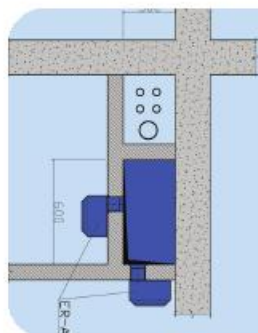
Установка 2 вентиляторов ER-APB-60 на стену шахты
